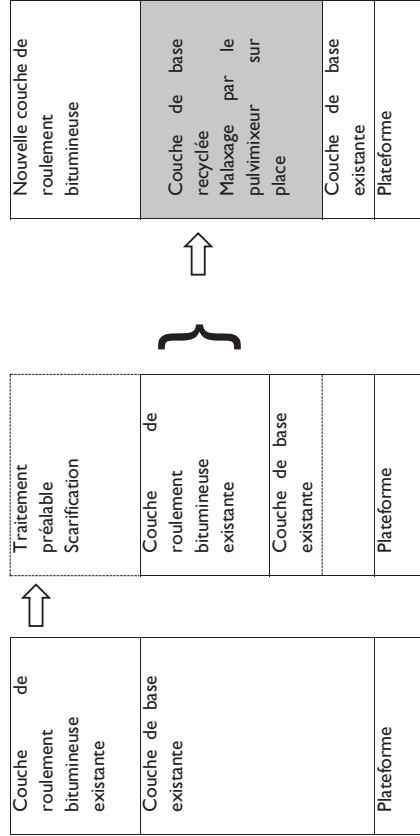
Exemple de travaux de stabilisation avec traitement préalable (nivellement)
